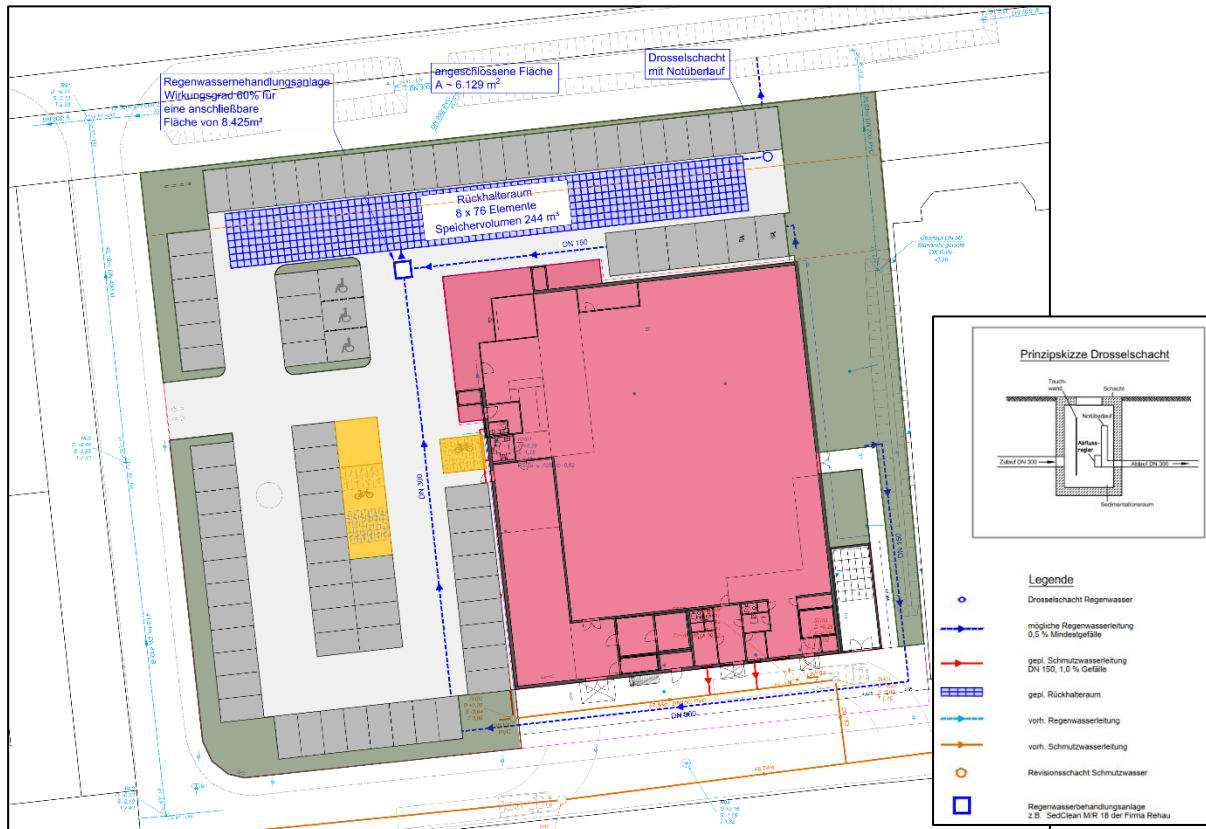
Lageplan mit der geplanten Entwässerung, Quelle: Ingenieurbüro Börjes
